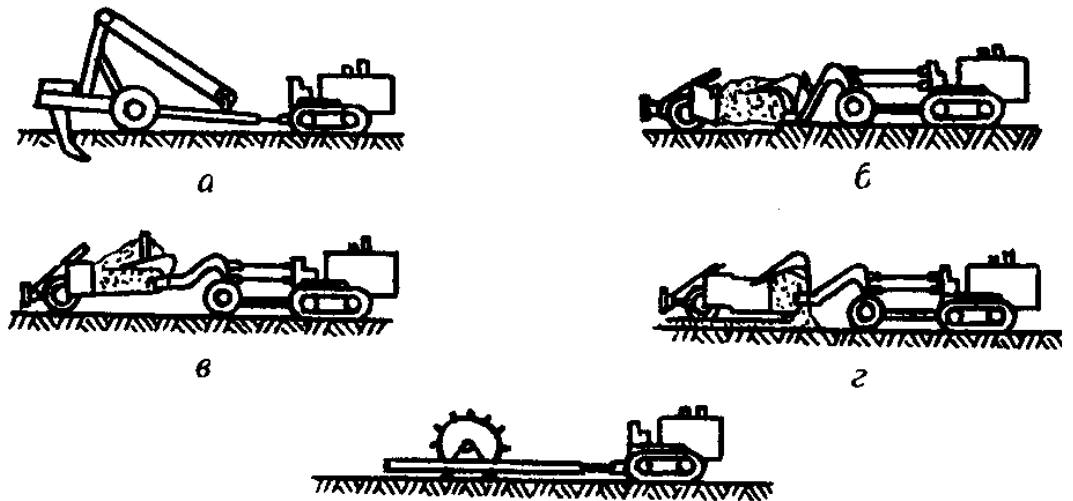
Схема комплексной механизации земляных работ при разработке грунта скрепером: а – рыхление; б – набор грунта; в – транспортирование; г – разгрузка скрепера; д - уплотнение
